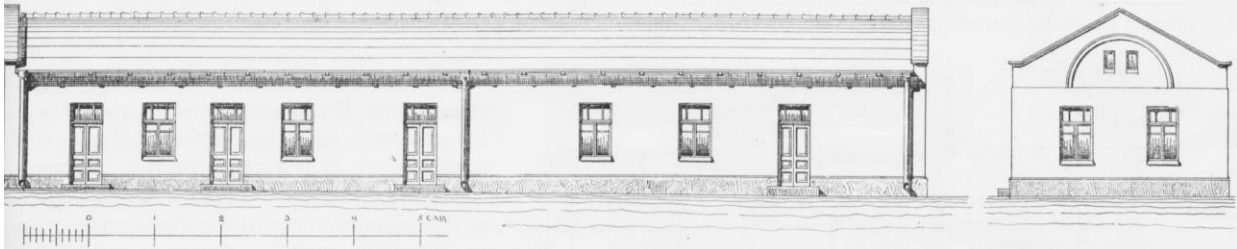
Домъ для рабочихъ съ прачешной и баней (по проекту). Слева — дворовый фасадъ, справа — фасадъ къ лиману.
